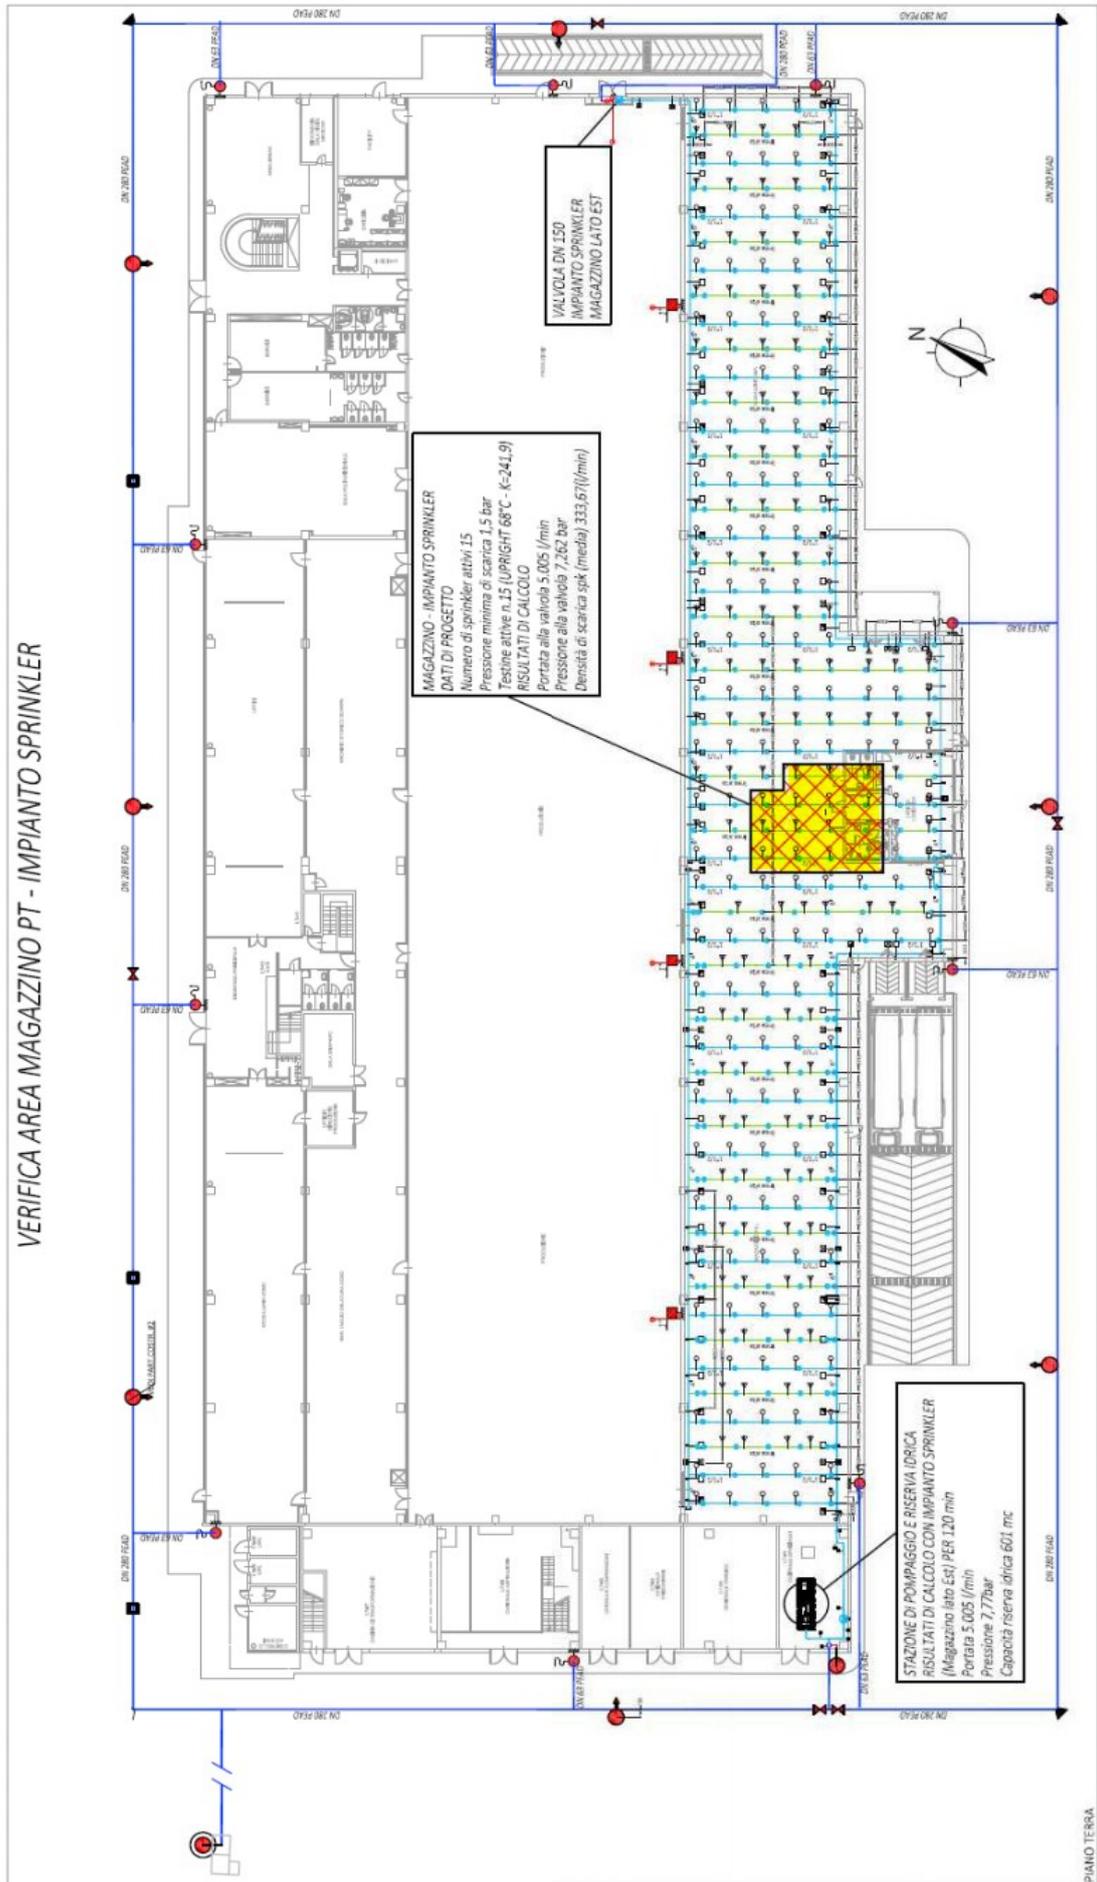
Planimetria area oggetto di verifica calcolo 2
